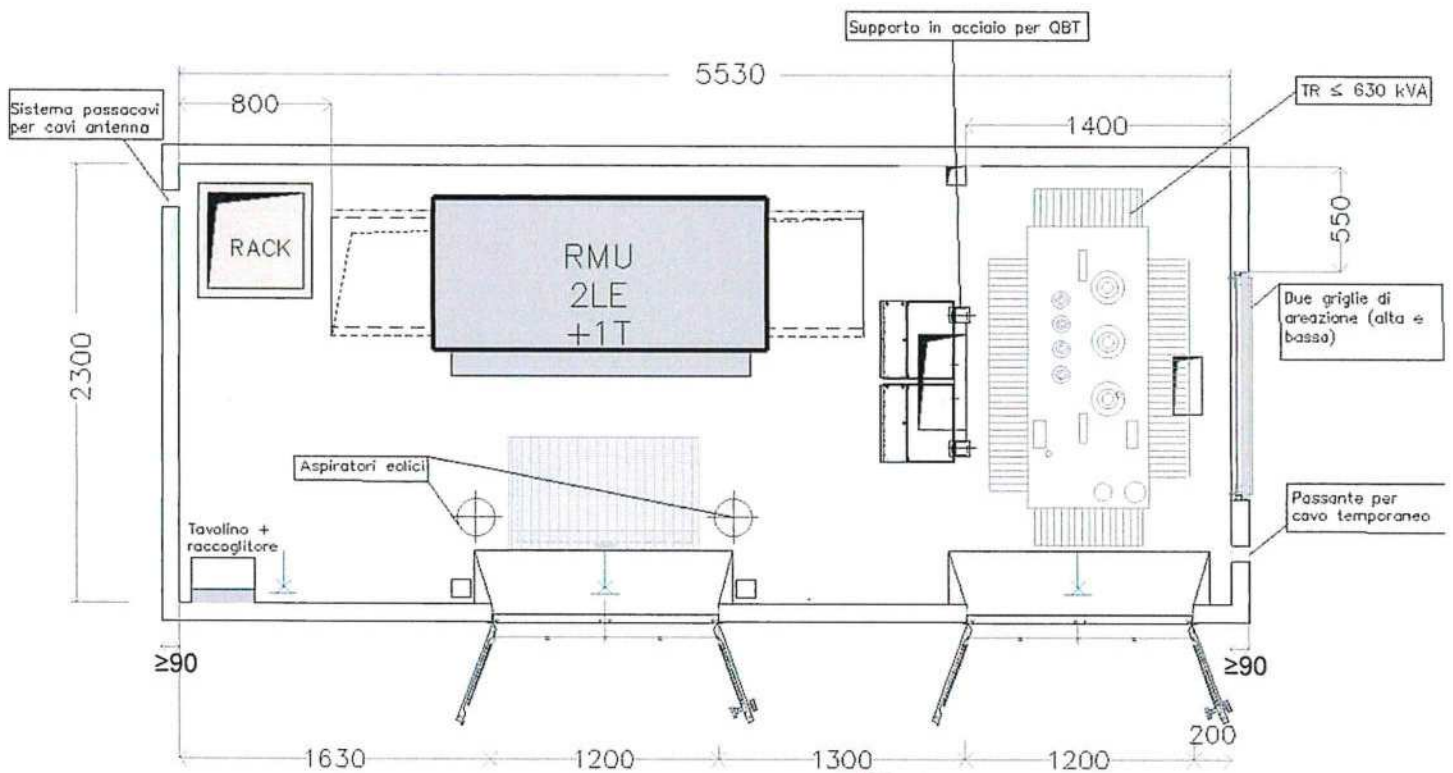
Pianta dimensionale e funzionale Standard Box Distribuzione (esempio installazione RMU 2LE+1T) – Ulteriori dimensioni nel §14.1
